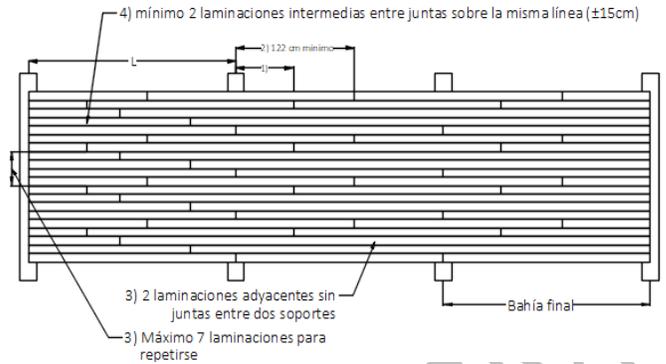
MLC tipo 4, laminaciones con juntas controladas sobre 4 o más apoyos
